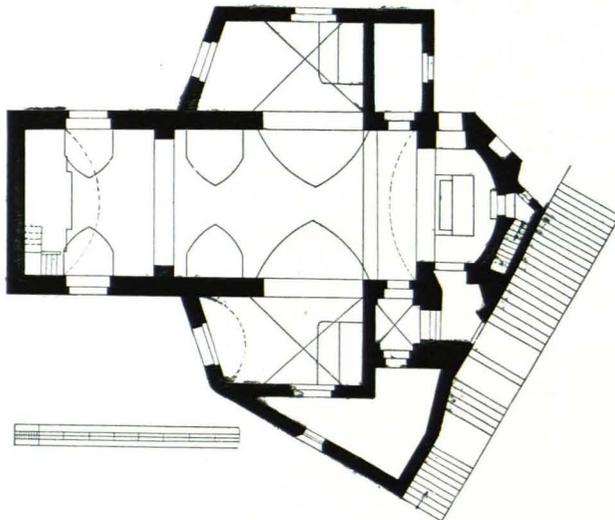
St. Johann am Imberg, Grundriß 1 : 300 (S. 172)
